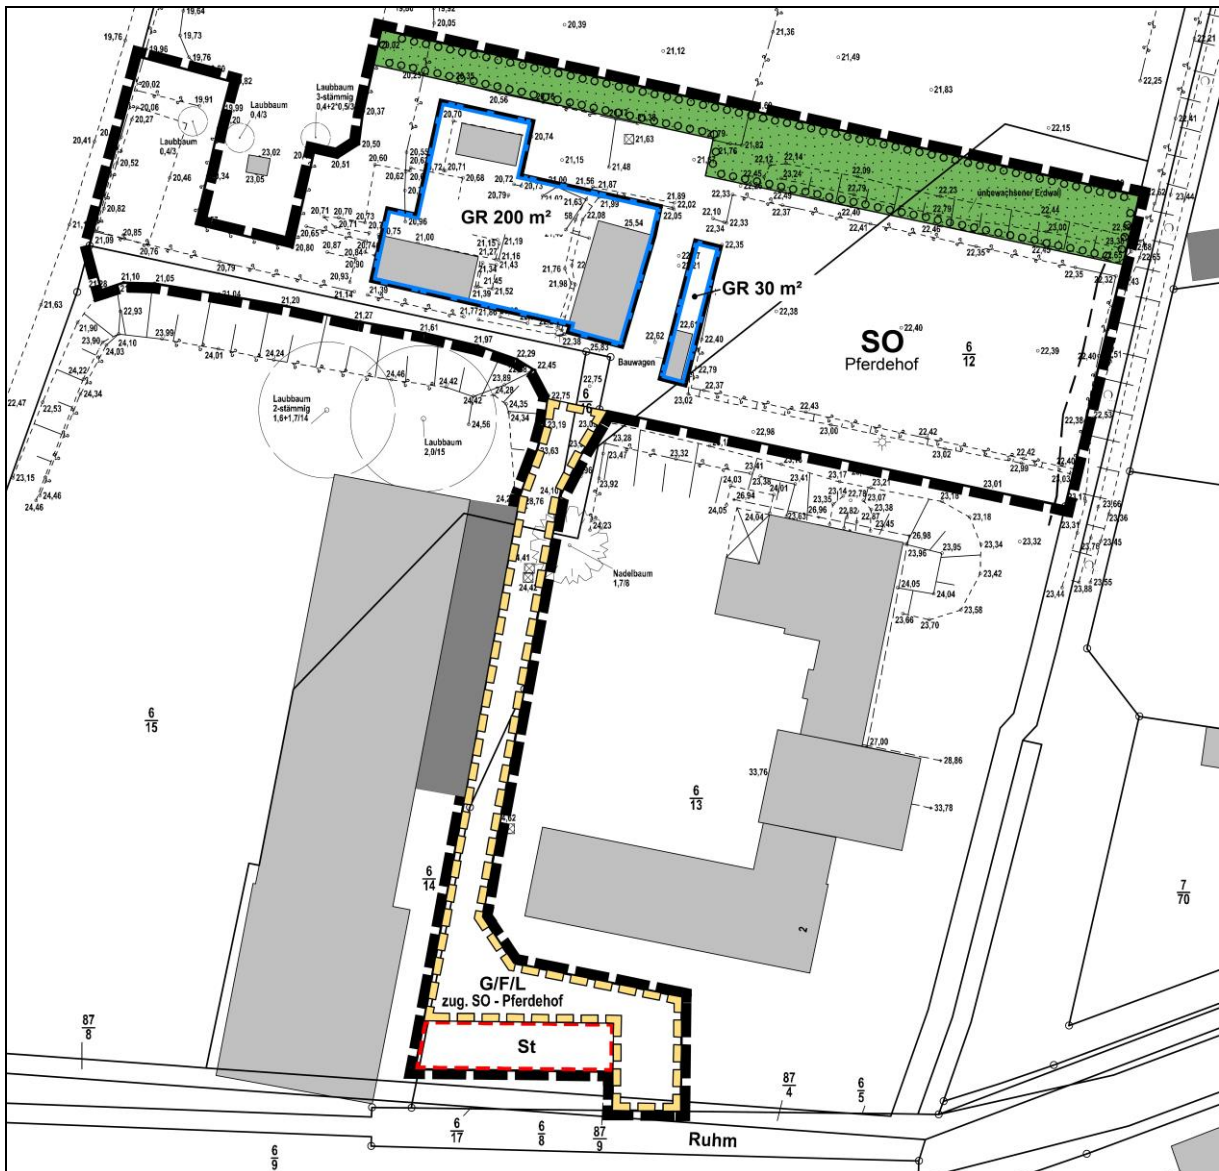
Auszug aus der Planzeichnung des B-Plans Nr. 14 (Quelle: Guntram Blank, Architekturbüro für Stadtplanung, Stand: 19.08.2021)
